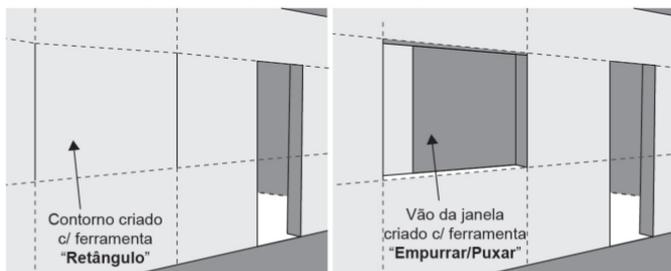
| Cópia da aresta da parede e extrusão da nova face
